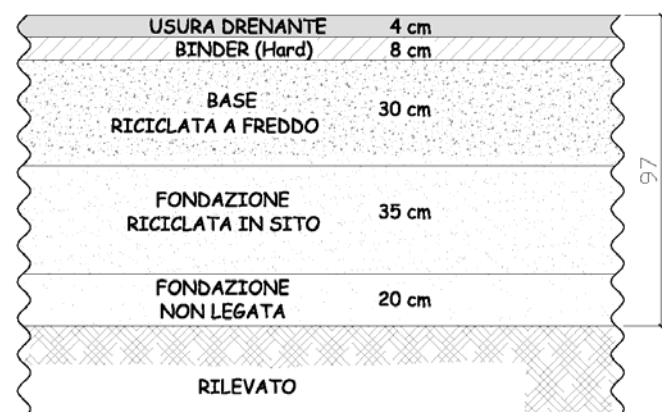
Pacchetto nuova pavimentazione tratto Monsummano
